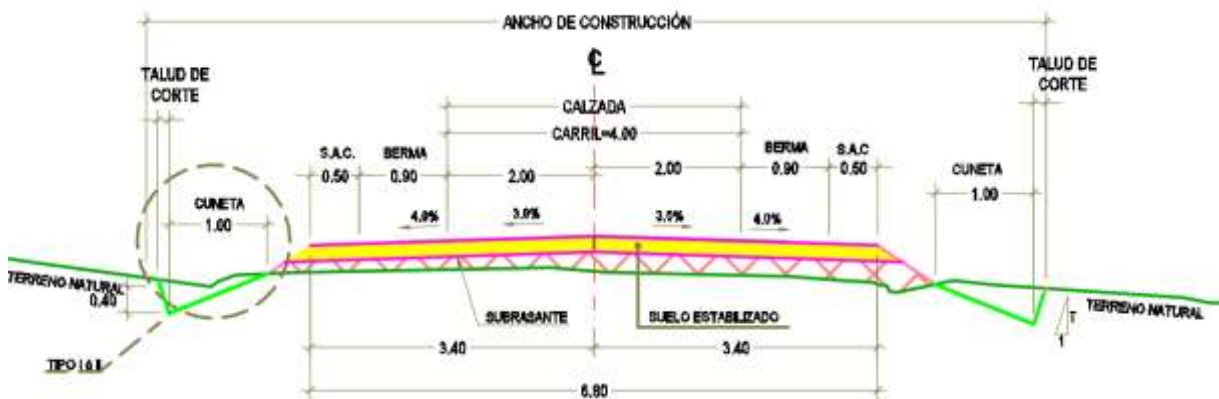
Sección típica particular con cuneta baja ambos lados. Fuente: Plano de secciones típicas.
